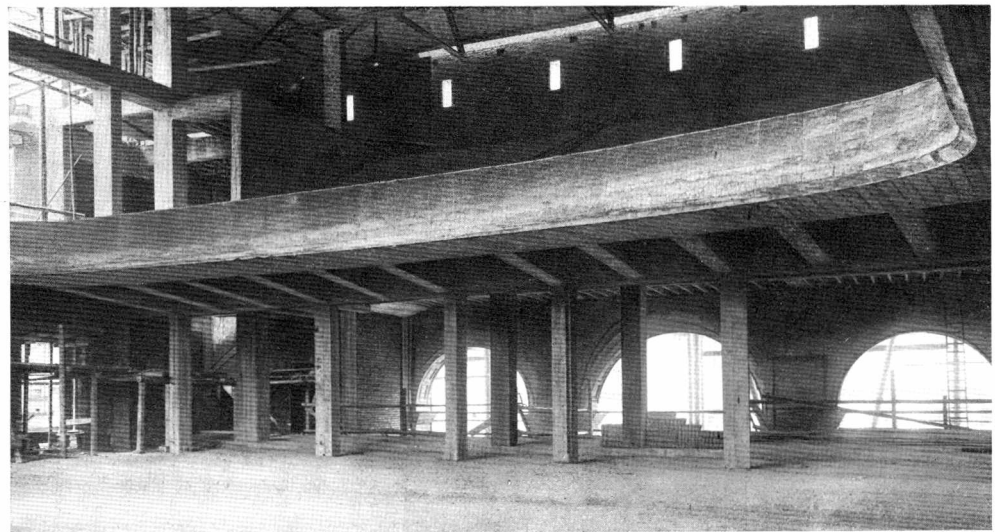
Ufapalast, Stuttgart. Balkonkonstruktion (Ludwig Bauer, Stuttgart) Phot. Dr. Lossen
